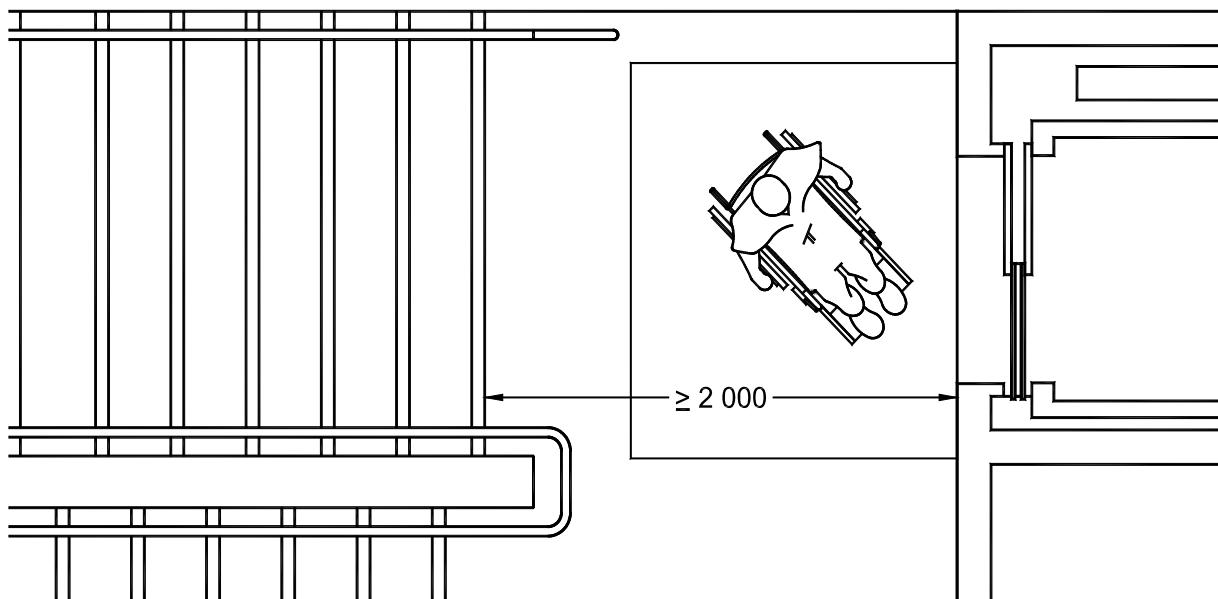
Espacio de maniobra por fuera de la puerta de la cabina, opuesto a una escalera
